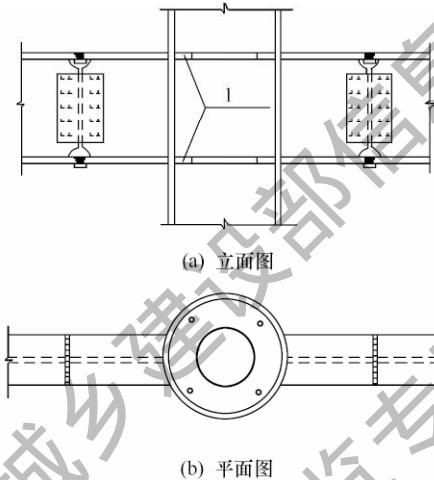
钢梁与圆形钢管混凝土柱设置内加强环连接构造
